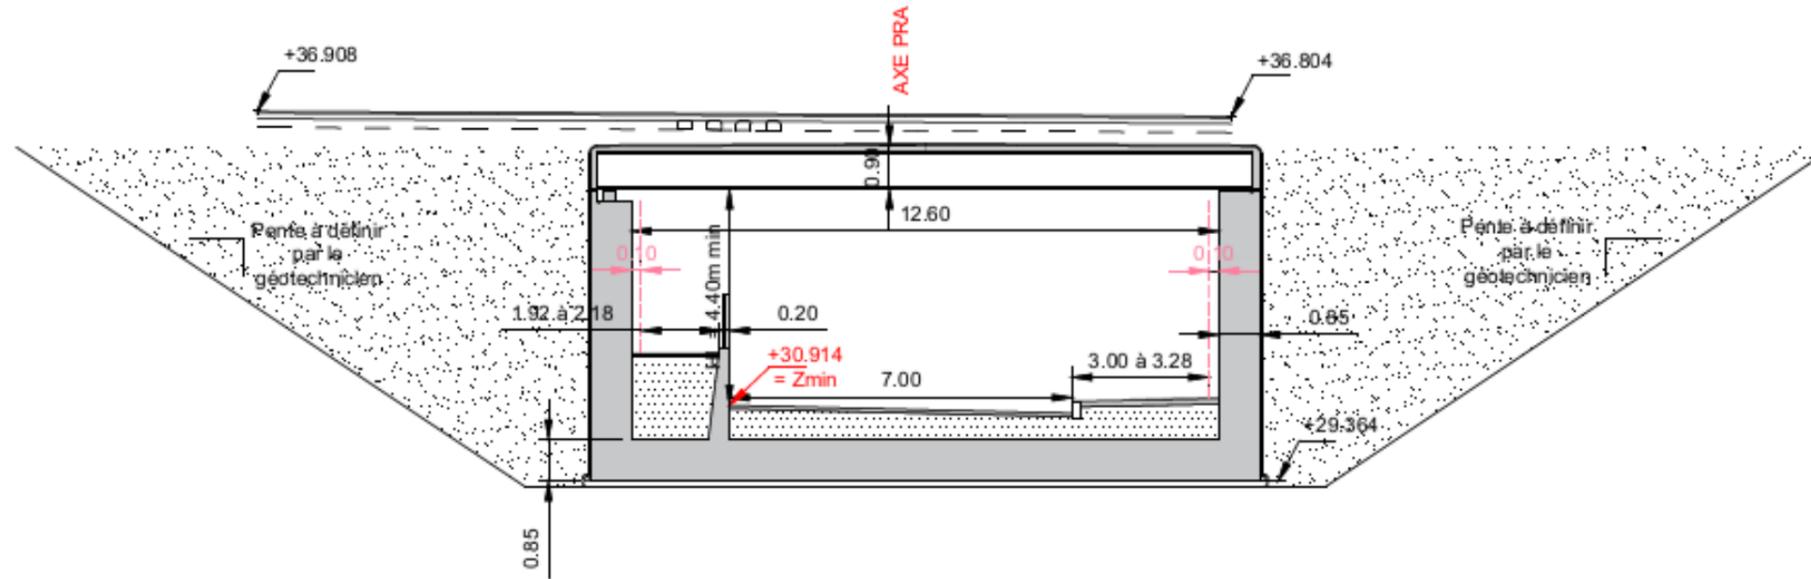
COUPE TRANSVERSALE AU NIVEAU DE L'AXE DU PRA
